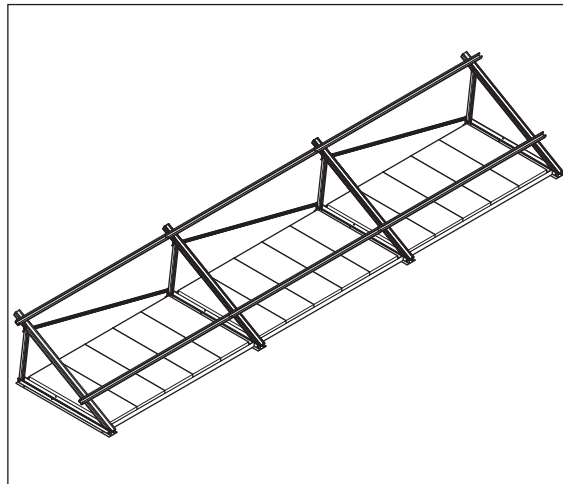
Exemple d'une ossature pour toit-terrasse pour 3 capteurs plans (EKSH26P)
